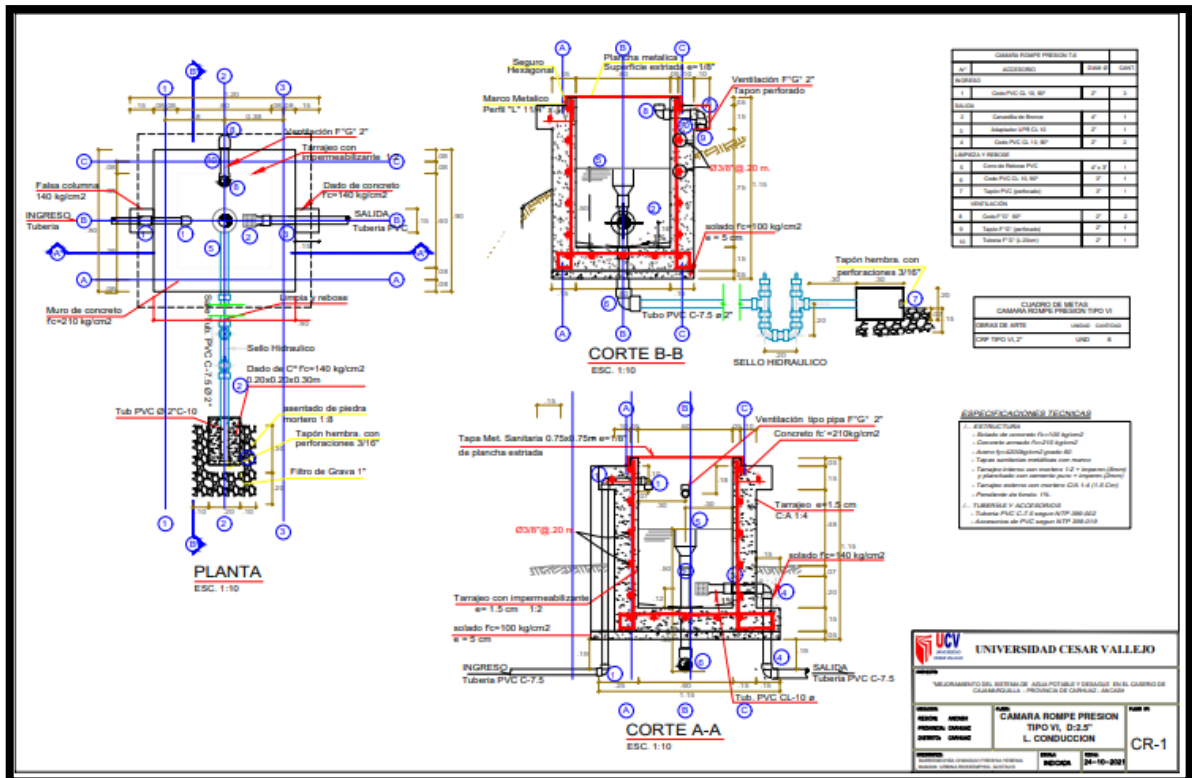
Plano Cámara Rompe Presión Tipo VI.
